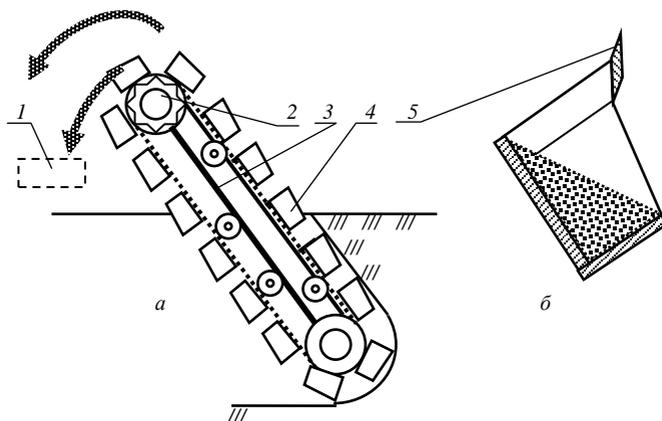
Схема цепного траншеекопателя с обратным наклоном рабочего органа: *а* – схема рабочего органа; *б* – схема скребка; 1 – поперечный конвейер; 2 – ведущая звездочка; 3 – рама; 4 – скребки; 5 – режущая кромка
